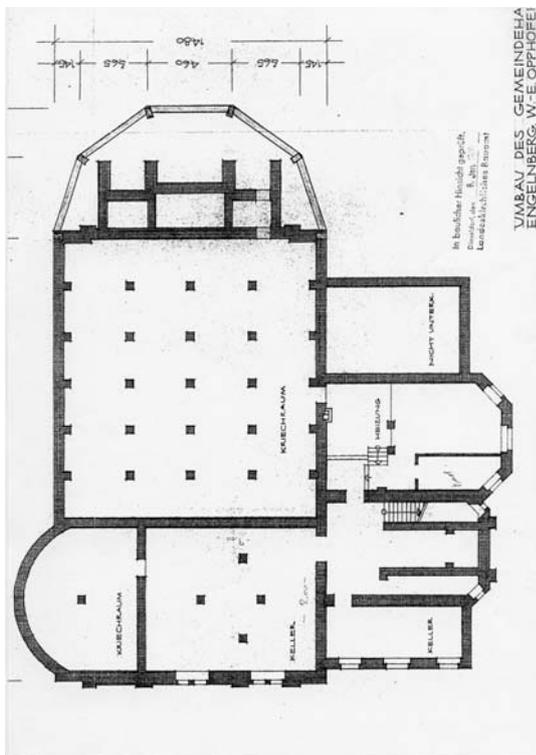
Grundriss Kellergeschoss, 1960
